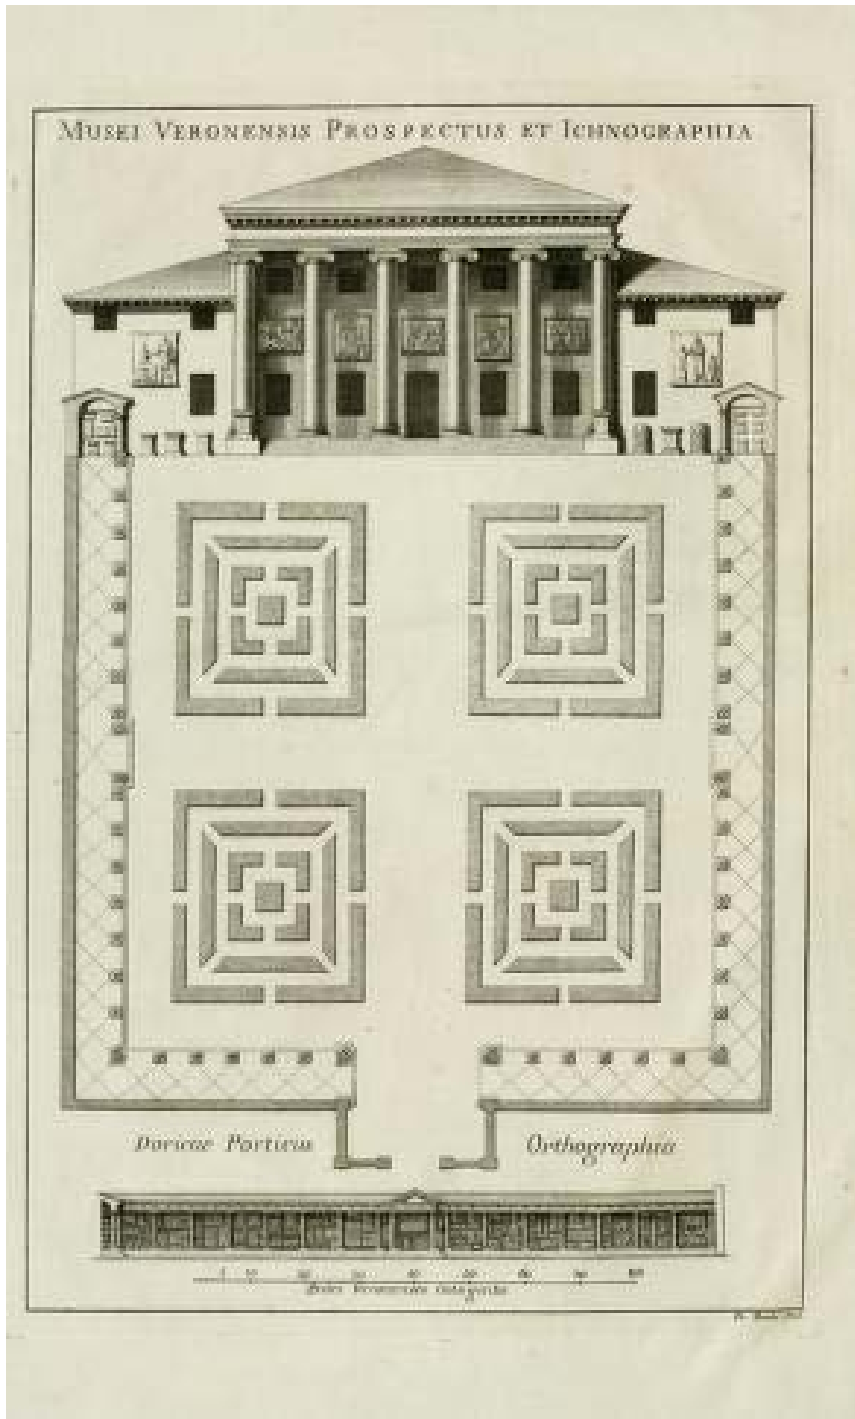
Pianta e prospetto del Museo Maffeiiano
